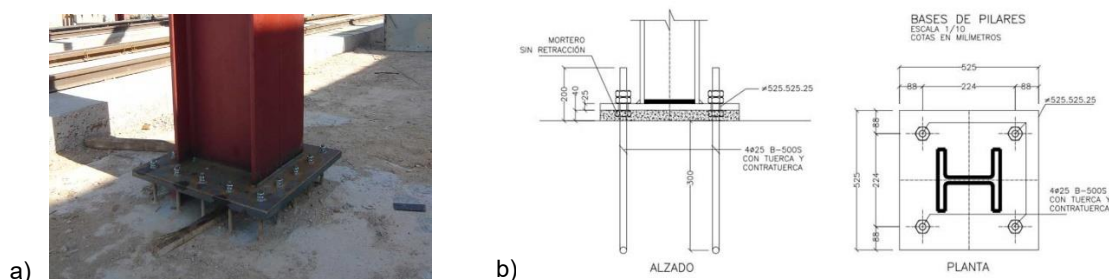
a) Fotografía placa de anclaje de pilares metálicos sobre hormigón. b) Ilustración técnica de placas de anclaje. Fuente: www.e-struc.com/
